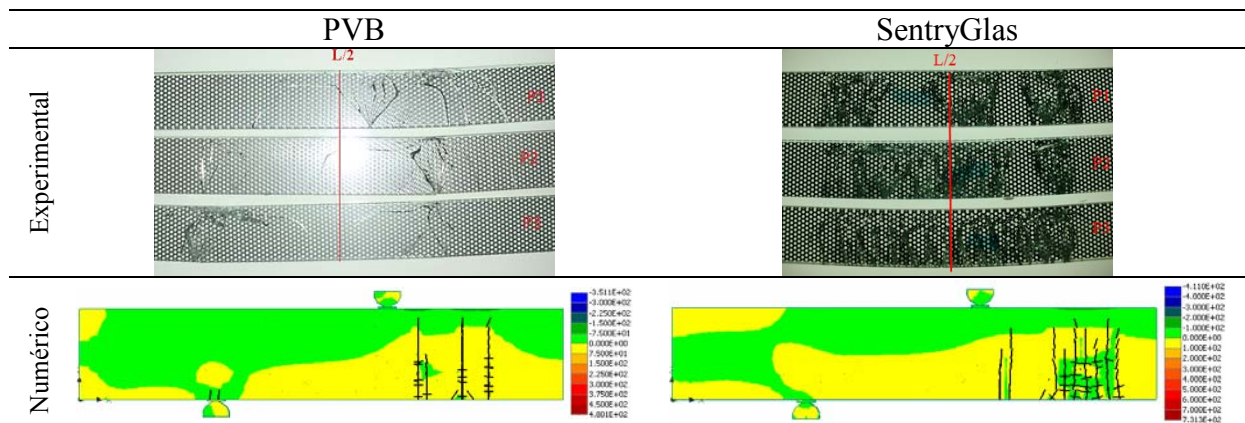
Fendilhação do vidro em vigas reforçadas com chapa metálica perfurada
